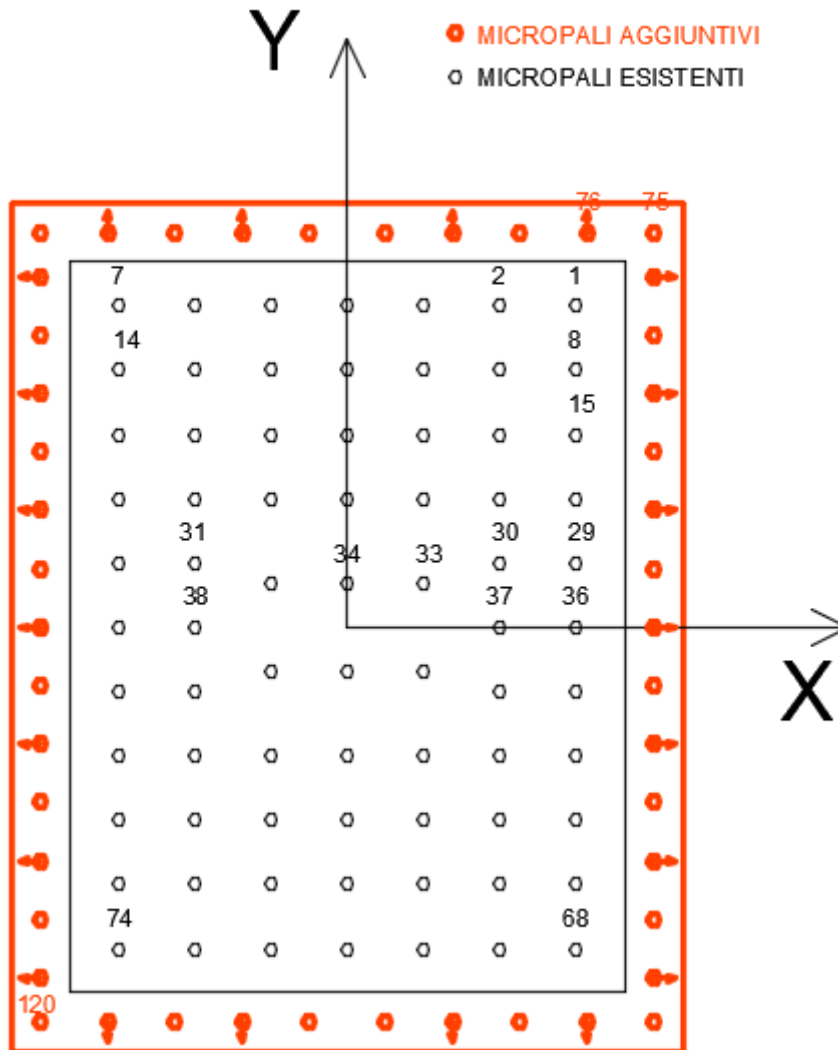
Pila P17-P20 – Configurazione di progetto di miglioramentosismico - pianta
